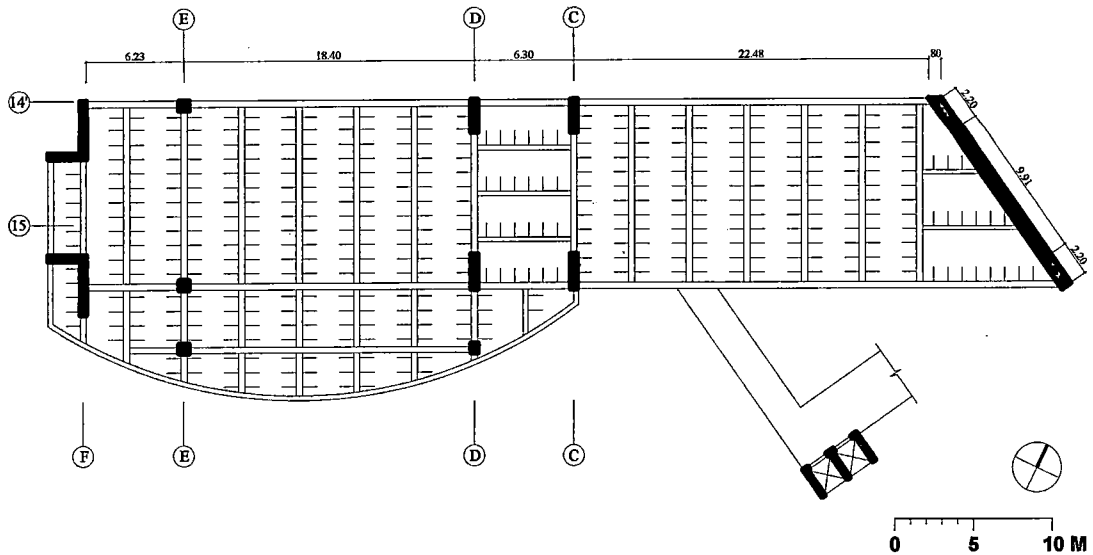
Proyecto [Bloque 3: Plano de Losa Colaborante]
